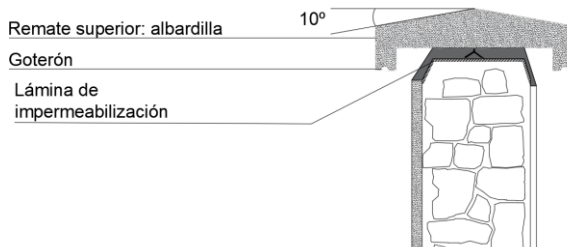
Detalle coronación de antepecho de fachada. Fuente: CAD Propio.
